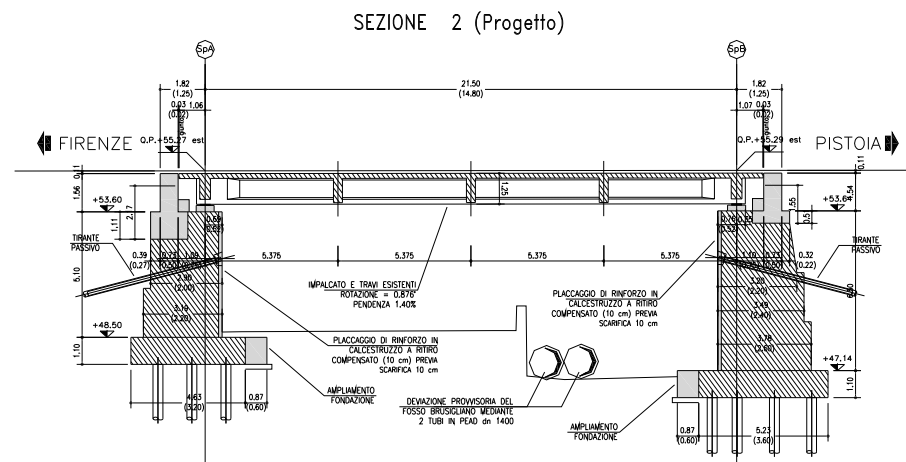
Sezioni longitudinale implacato con spalle
